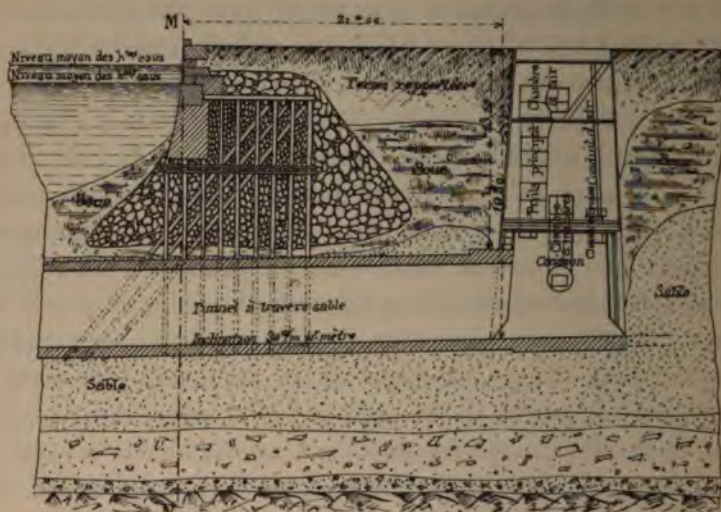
Coupe en long du souterrain et du caisson. — Côté New-York.
